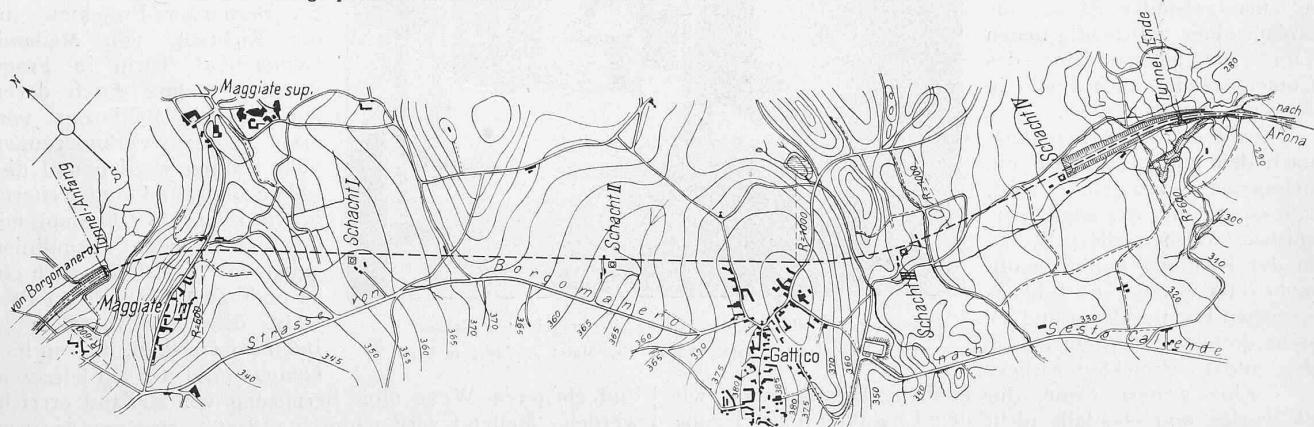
Lageplan des Gattico-Tunnels. — Masstab 1 : 20 000.
